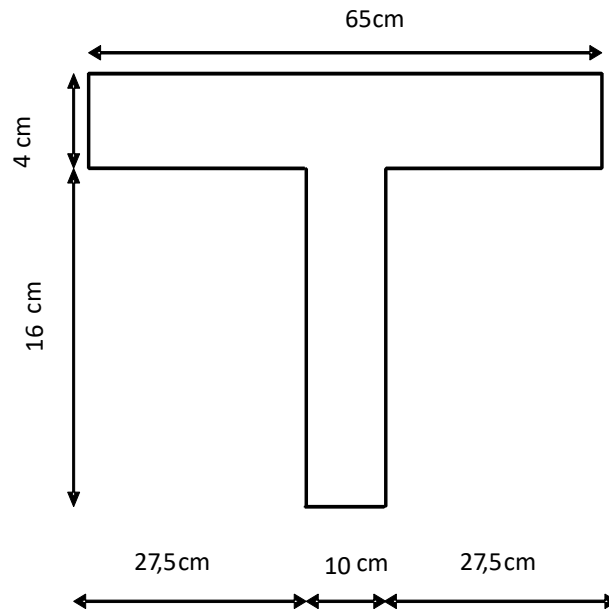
Schéma de prédimensionnement du plancher.
